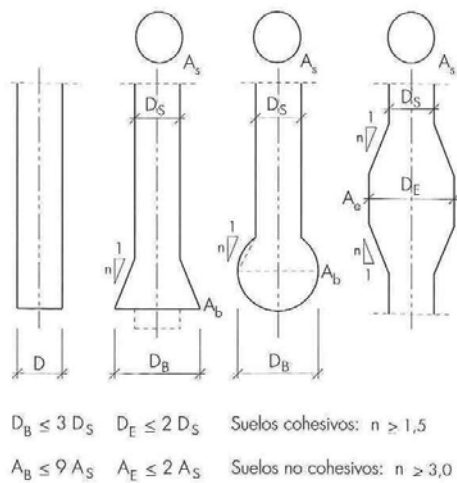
Pilotes de fuste recto, base ensanchada y fuste ensanchado
